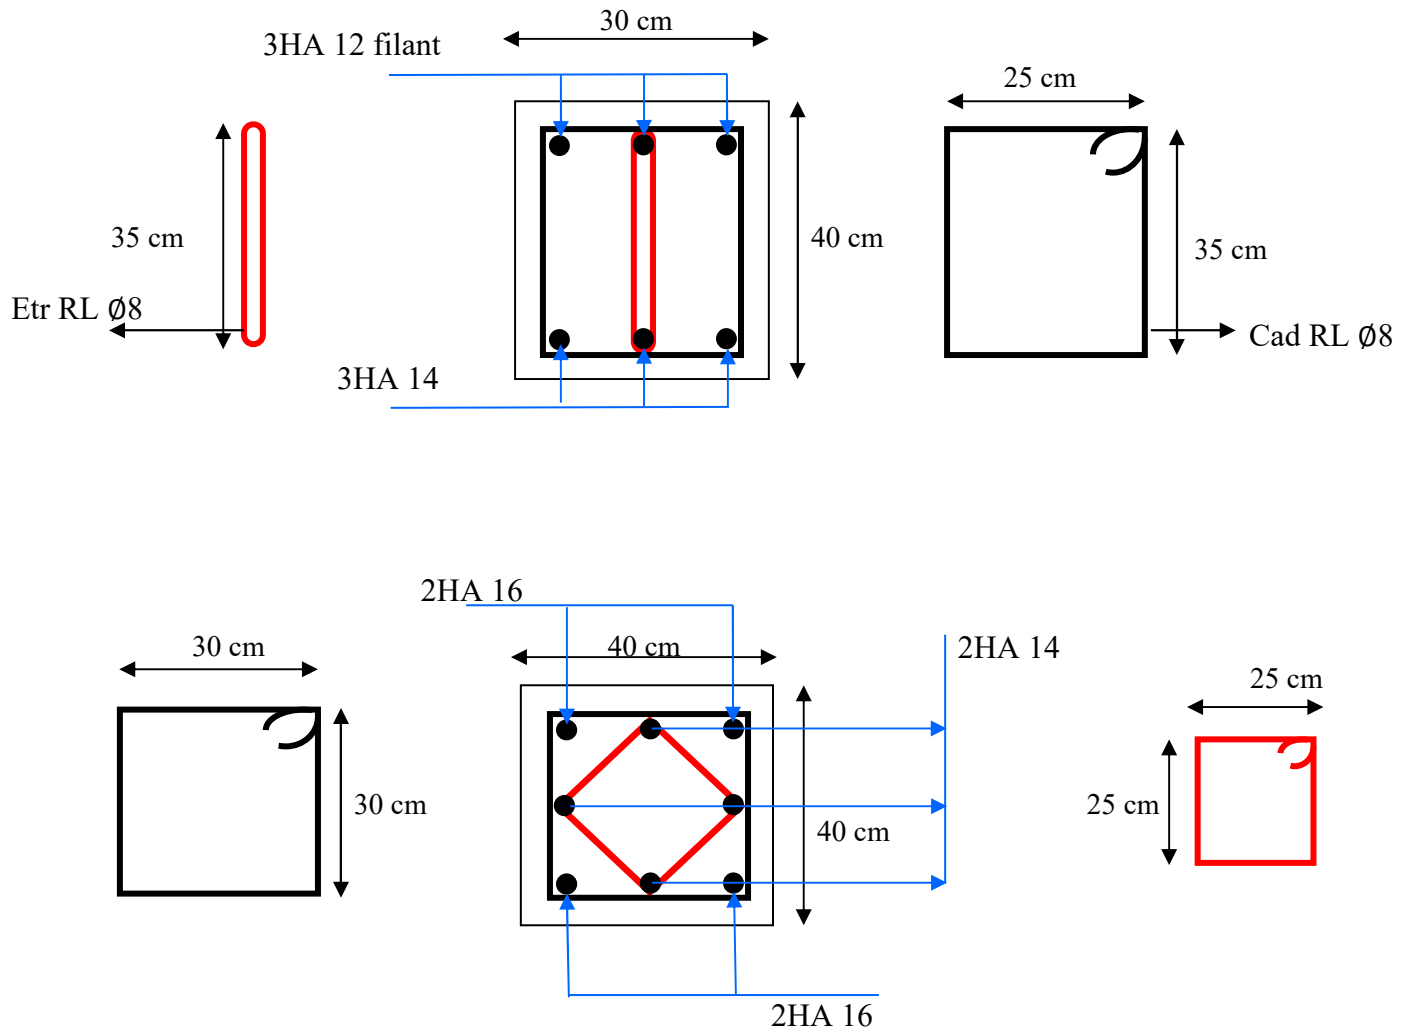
Sections et ferrailage des poteaux et poutres.
